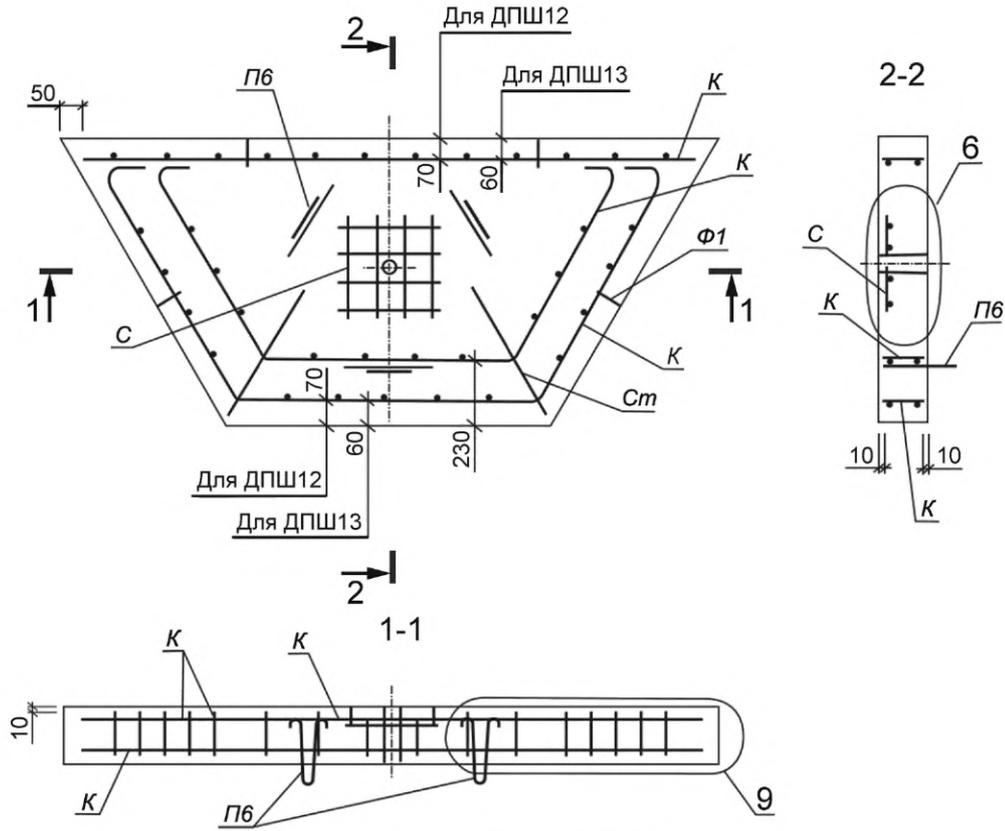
Схема армирования плит: ДПШ13, ДПШ12
